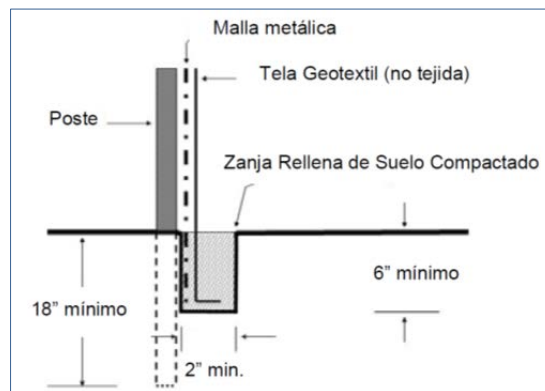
Detalles para la instalación de barreras de cieno Tipo A y B.
